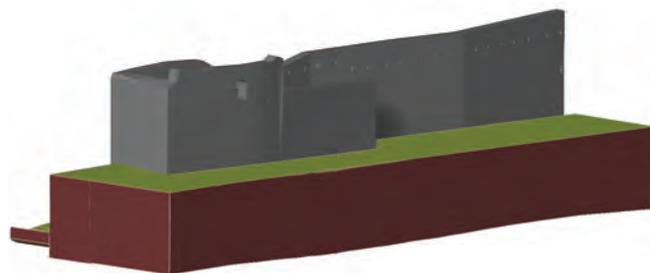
Roma. Mura Aureliane, cortina L32-33, posizione del muro rispetto alla rupe.
